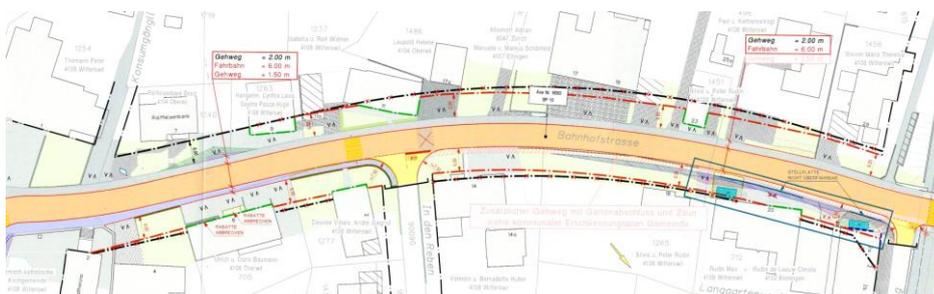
Gestaltungsbaulinien entlang der Bahnhof-, Benkenstrasse im rechtsgültigen Erschliessungsplan Abschnitt Ettingerstrasse - Ortsausgang (grün gestrichelt)
